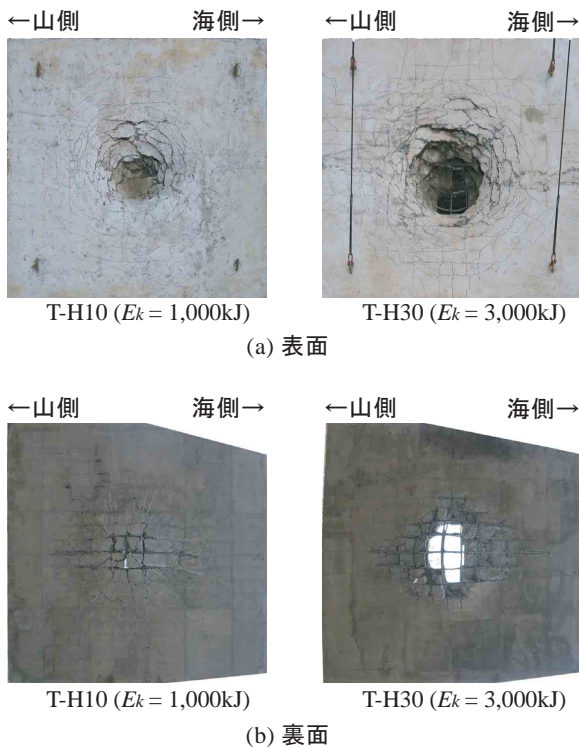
芯材 RC 版のひび割れ状況写真
